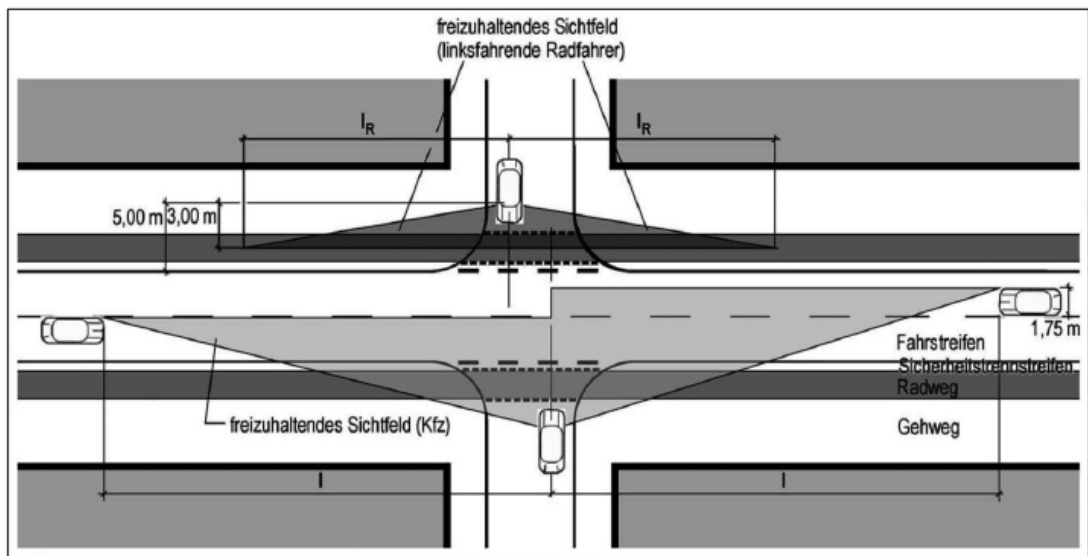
Sichtfelder auf bevorrechtigte Kraftfahrzeuge und Radfahrer (RSt 06 – FGSV, Bild 120)
